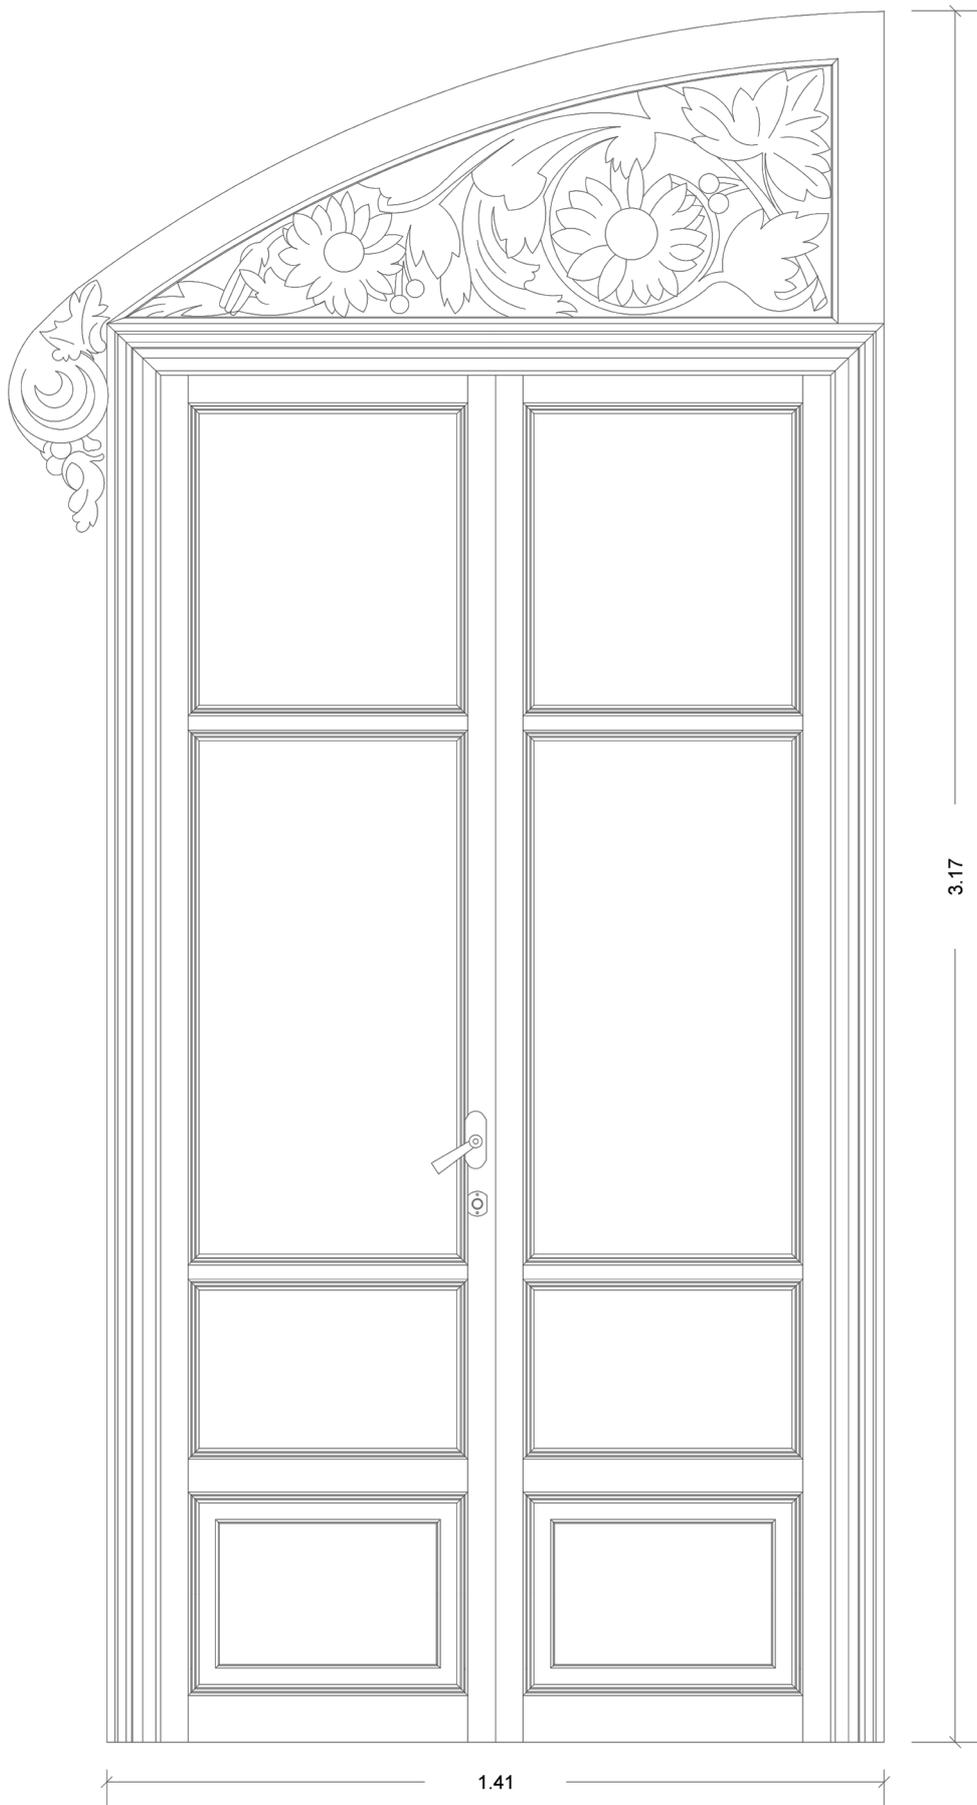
Dibujo de la puerta de acceso al comedor y dormitorio de la planta baja.
